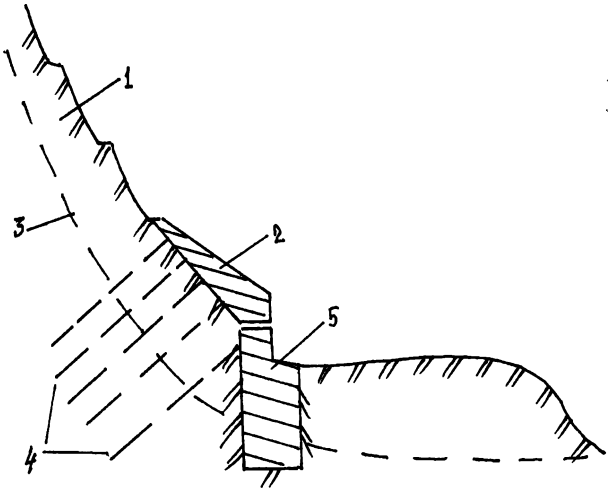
Схема крепления склона подпорной стенкой с анкерами:
